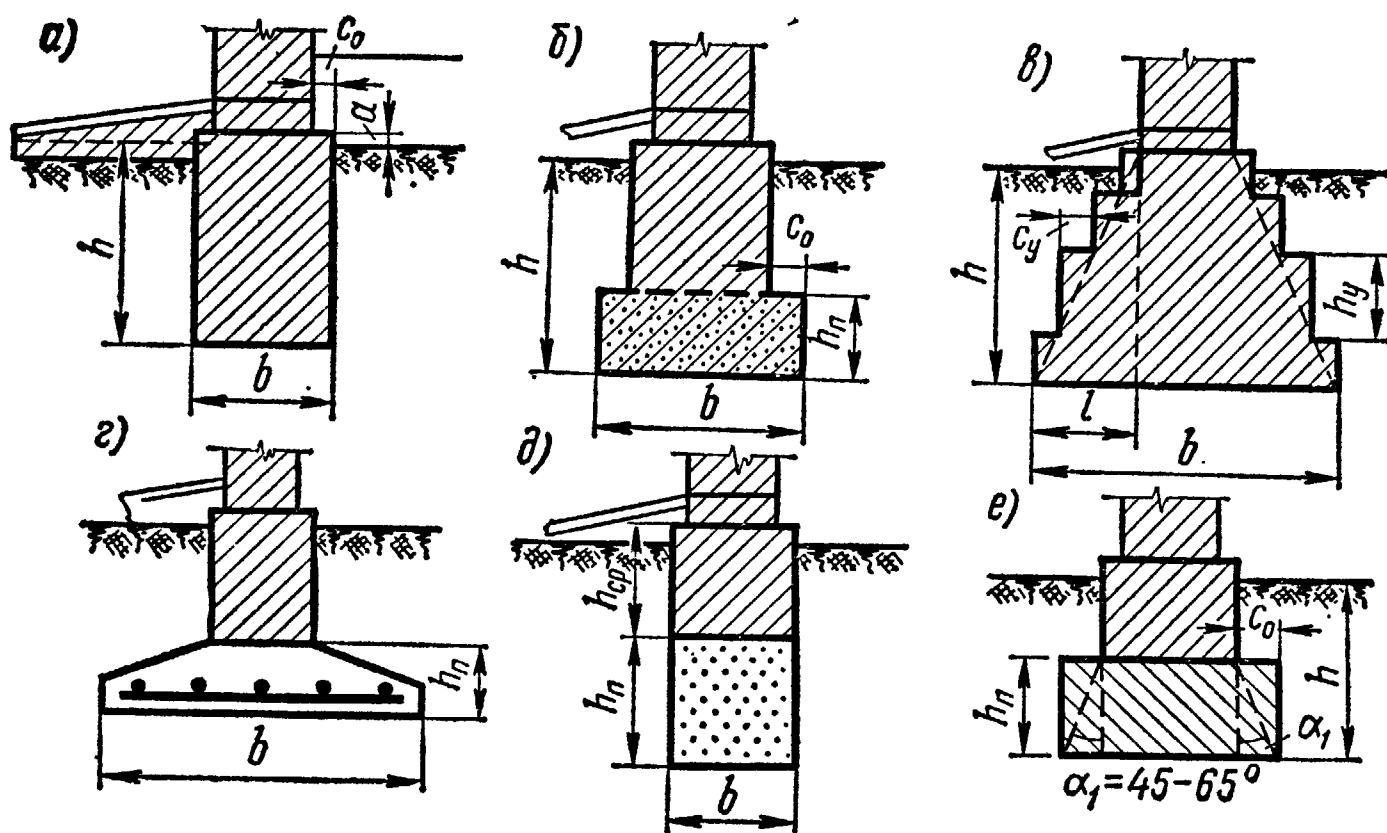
Поперечные сечения ленточных и смешанных фундаментов:
